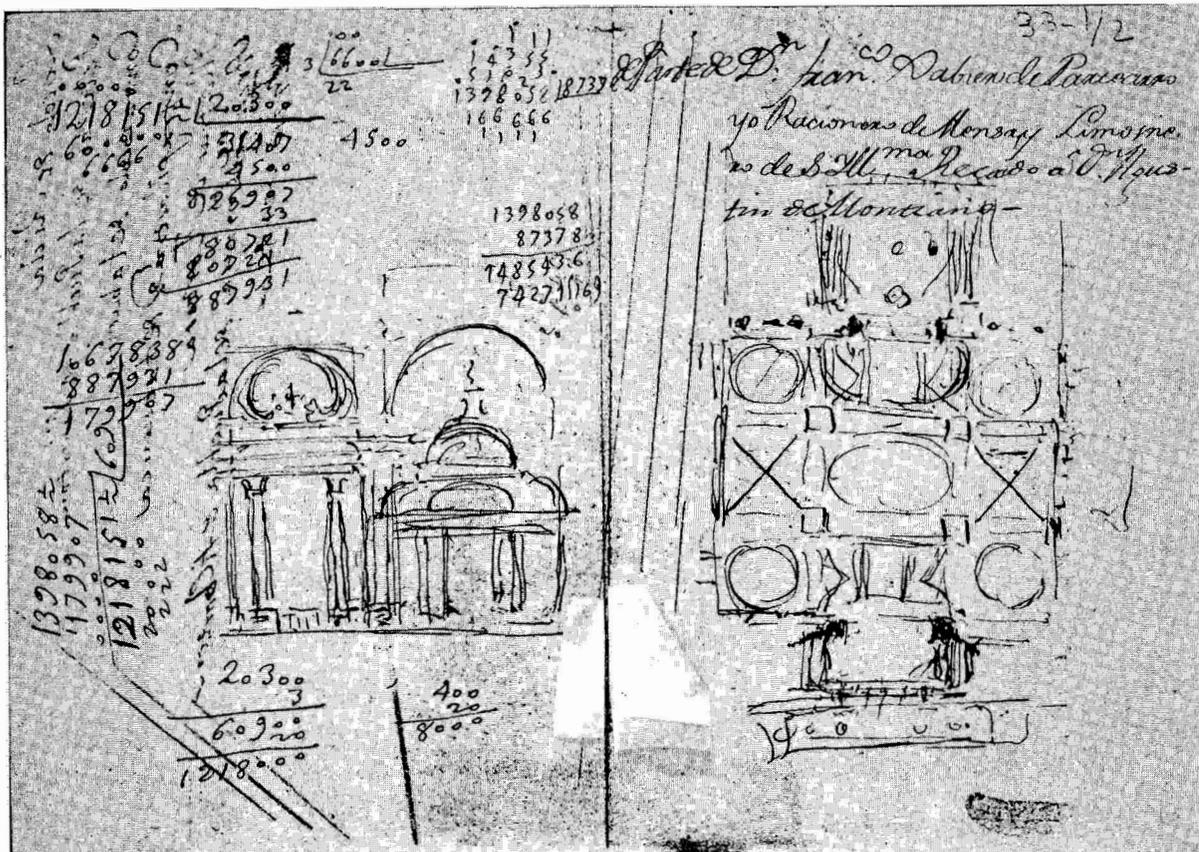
Dibujo n.º 2 recto. Baldaquinos y planta del espacio de la Santa Capilla.
